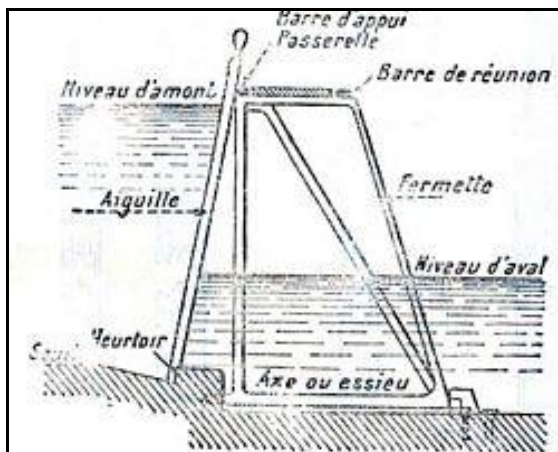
Schéma d'un barrage Poirée (Notions de navigation intérieure, E. Fourrey, 1946)
